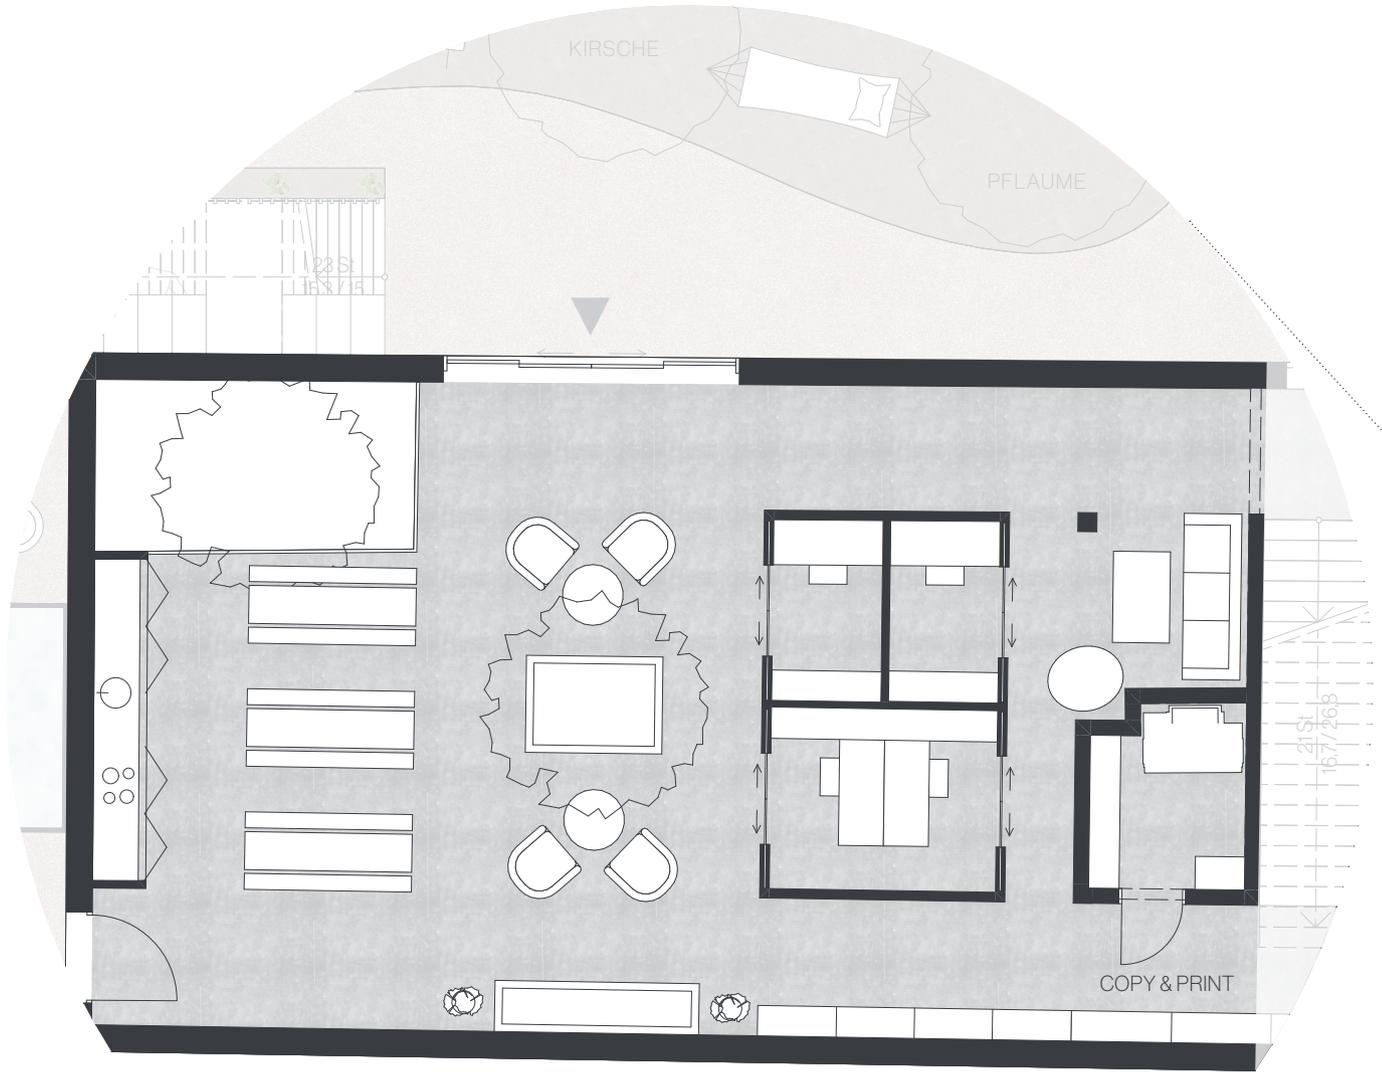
| Grundriss 1. Obergeschoß. Atelier 193
